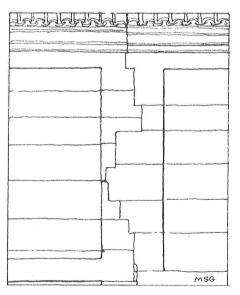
Encuentro de dos fachadas de sillería en Salamanca.
